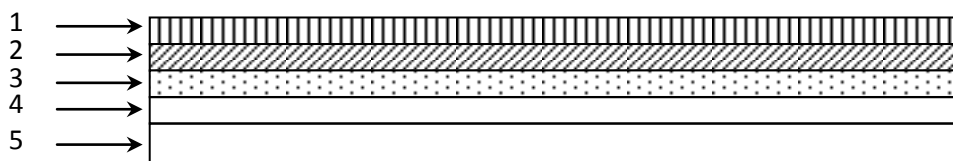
Coupe verticale d'un plancher étage courant à corps creux.
